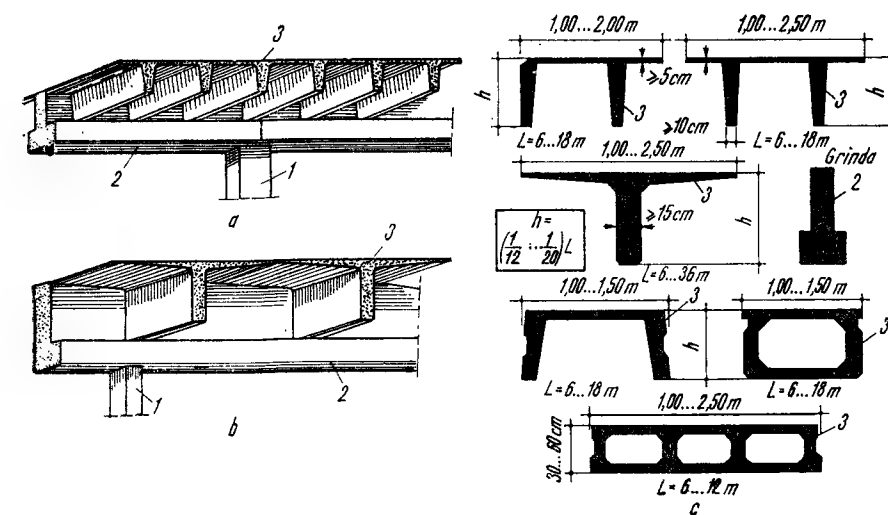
Planșee din grinzi prefabricate din beton precomprimat, greu sau ușor :
